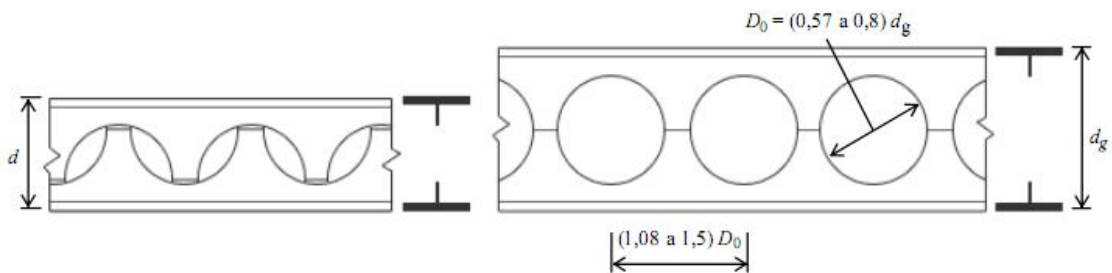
Geometria para fabricação de vigas celulares (SILVEIRA, 2011).
